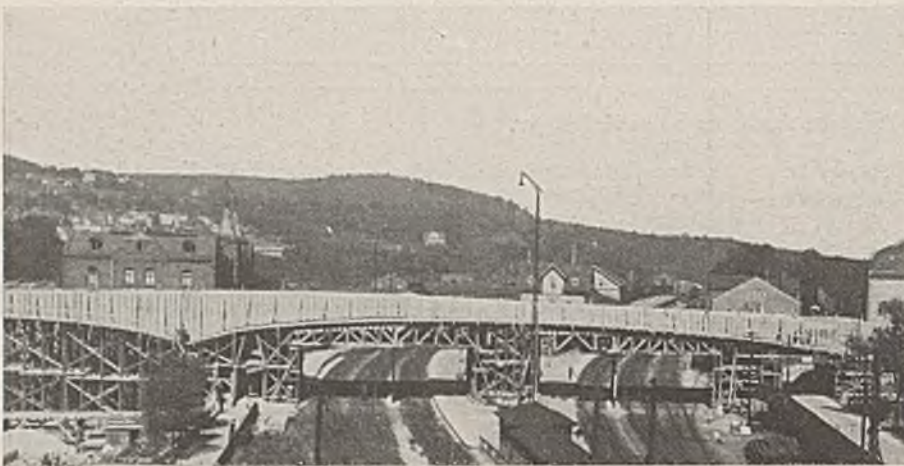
Bahnhofüberbrückung, Lehrgerüst.
